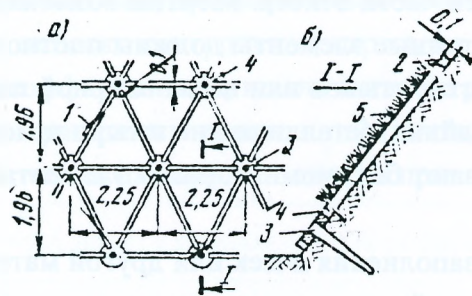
Схема решетчатых укреплений из сборных железобетонных элементов с монтажной плитой: а – план; б – разрез; 1 – монтажные железобетонные балочки; 2 – сечение балочки; 3 – свайки; 4 – монтажная плита; 5 – обсев травами по слою растительного грунта.
